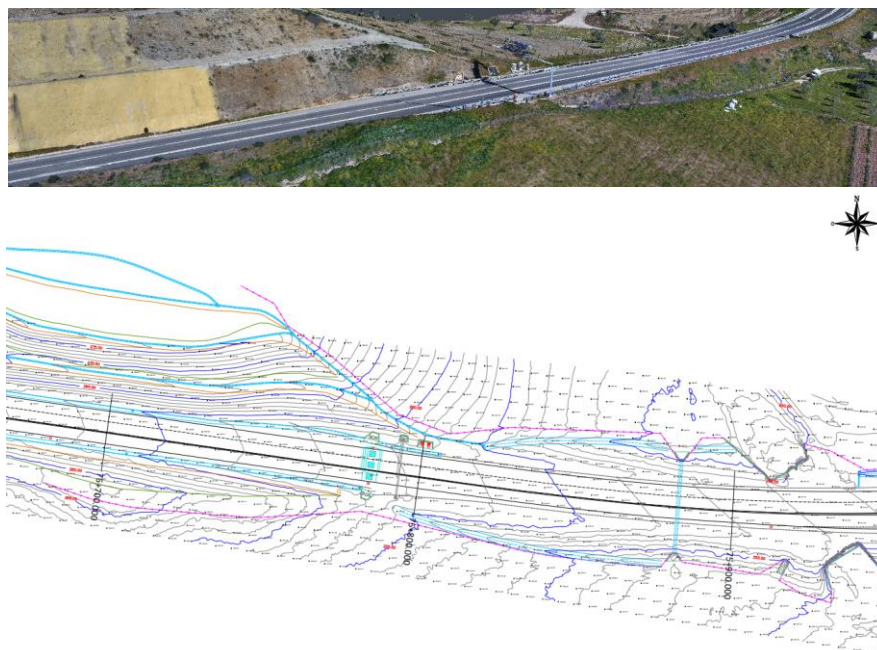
Nuvem de pontos (em cima) e planta (em baixo) de um troço rodoviário. Cortesia: Mota-Engil
